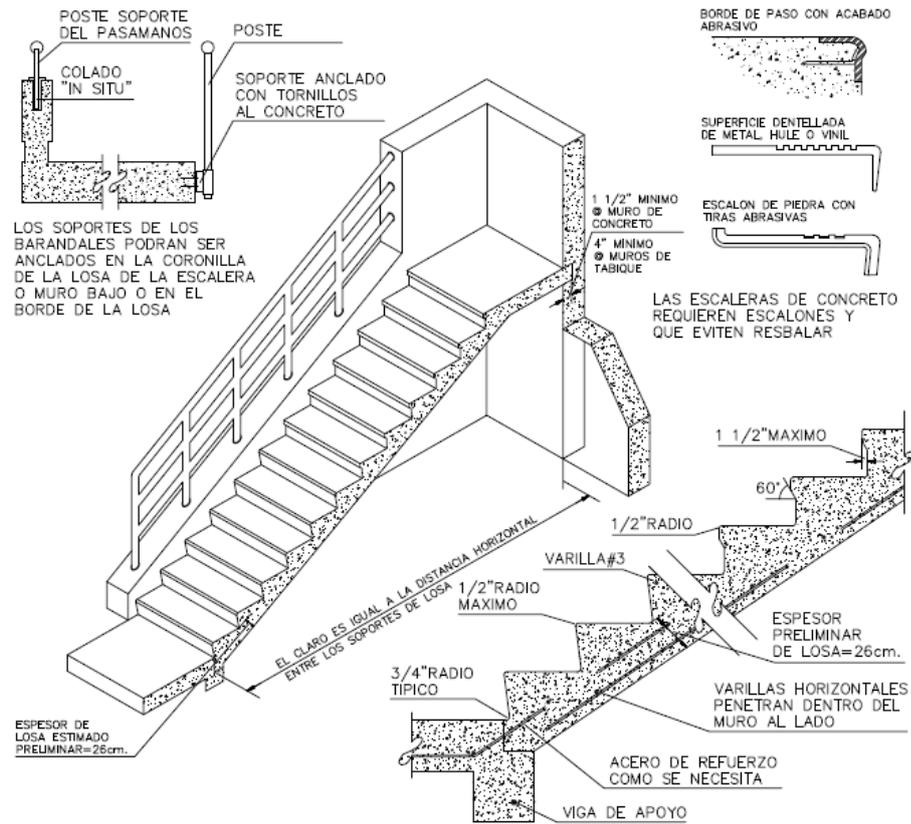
Detalle de escalera de concreto armado con pasos de madera
